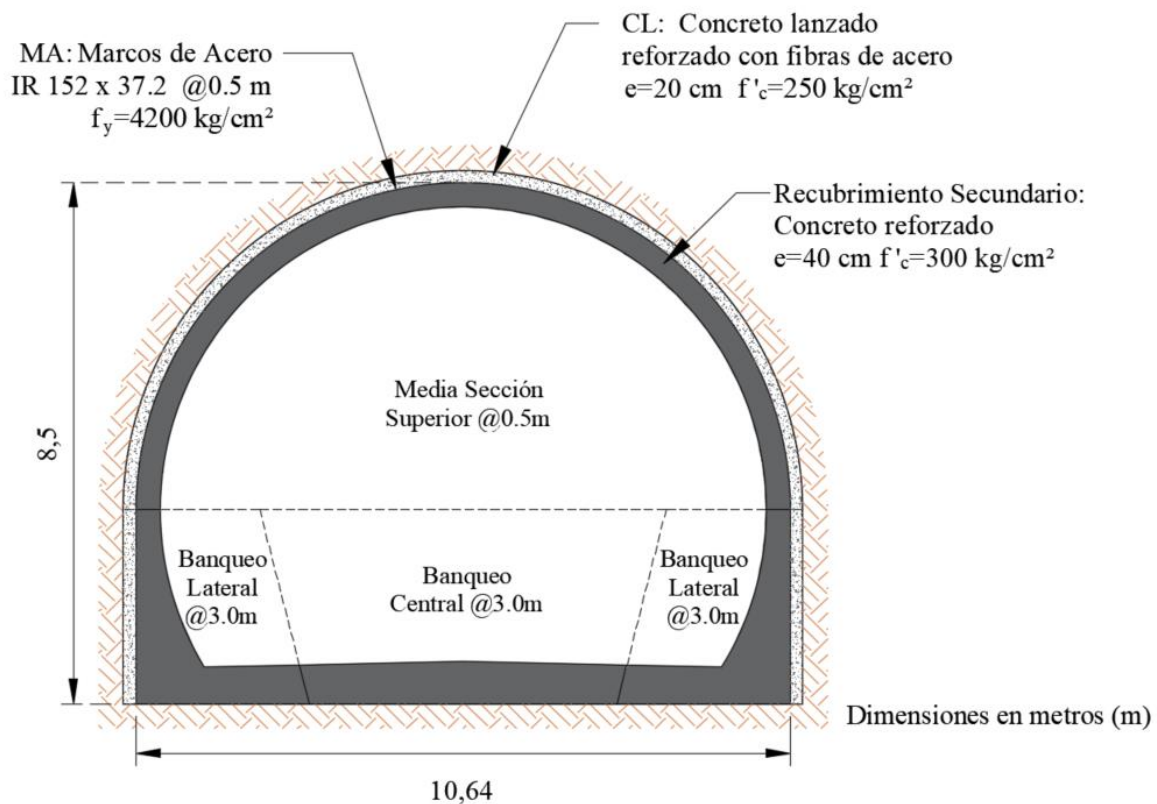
Sección transversal tipo correspondiente al tramo de túnel en estudio (dimensiones en metros).
